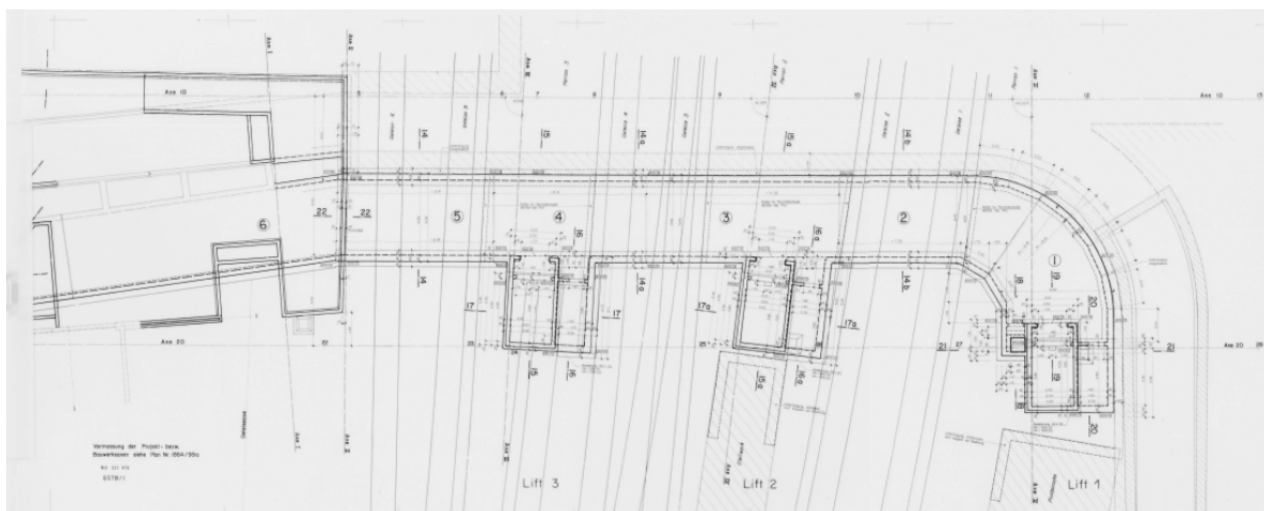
Untergeschoss/Posttunnel Stand Bauprojekt 1980
